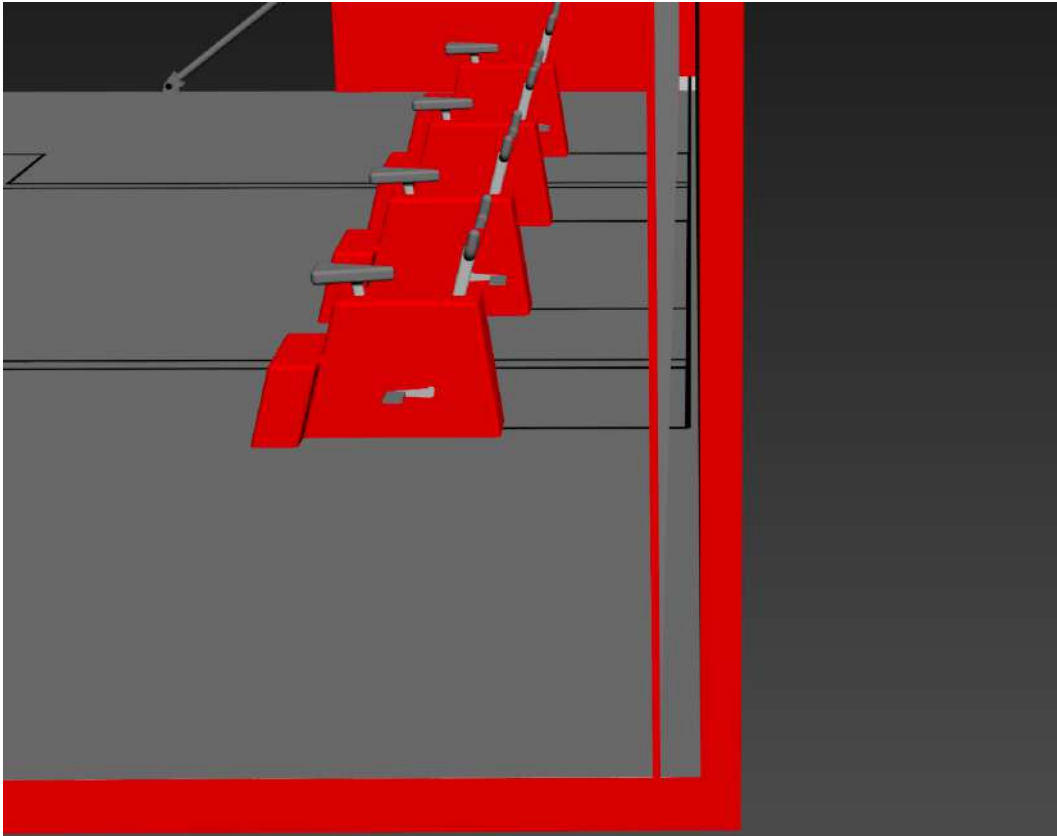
Render detalle falsa pared de cables container “Fuente: Elaboración propia”
